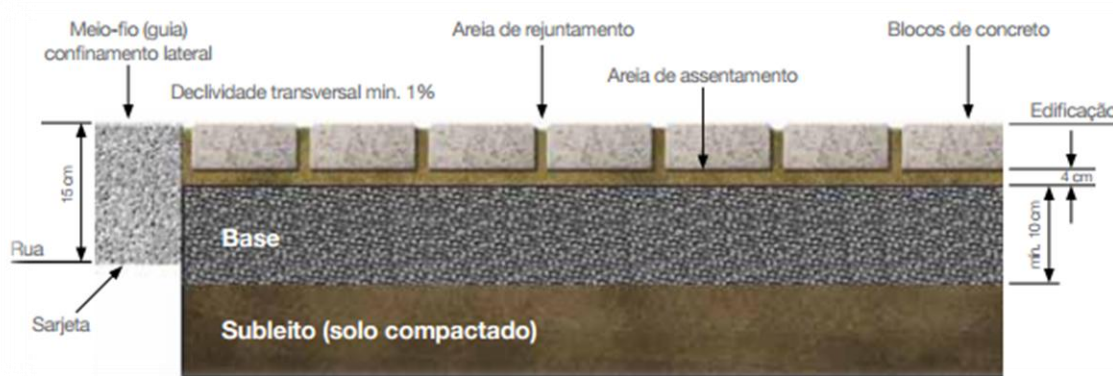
Estrutura típica do pavimento intertravado (ABCP, 2010)
